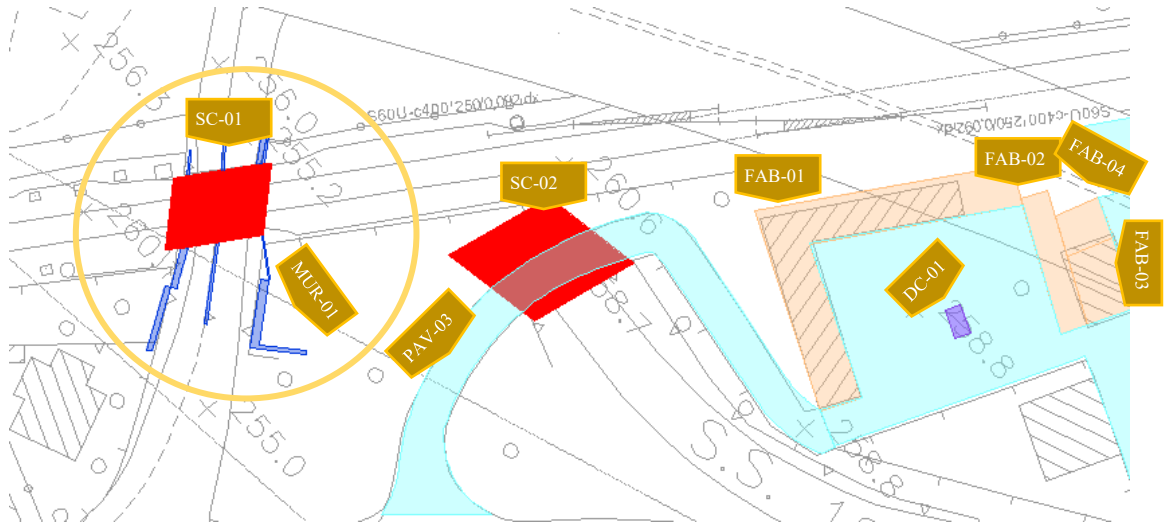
Stralcio planimetrico zona sottopasso via Gertrude
